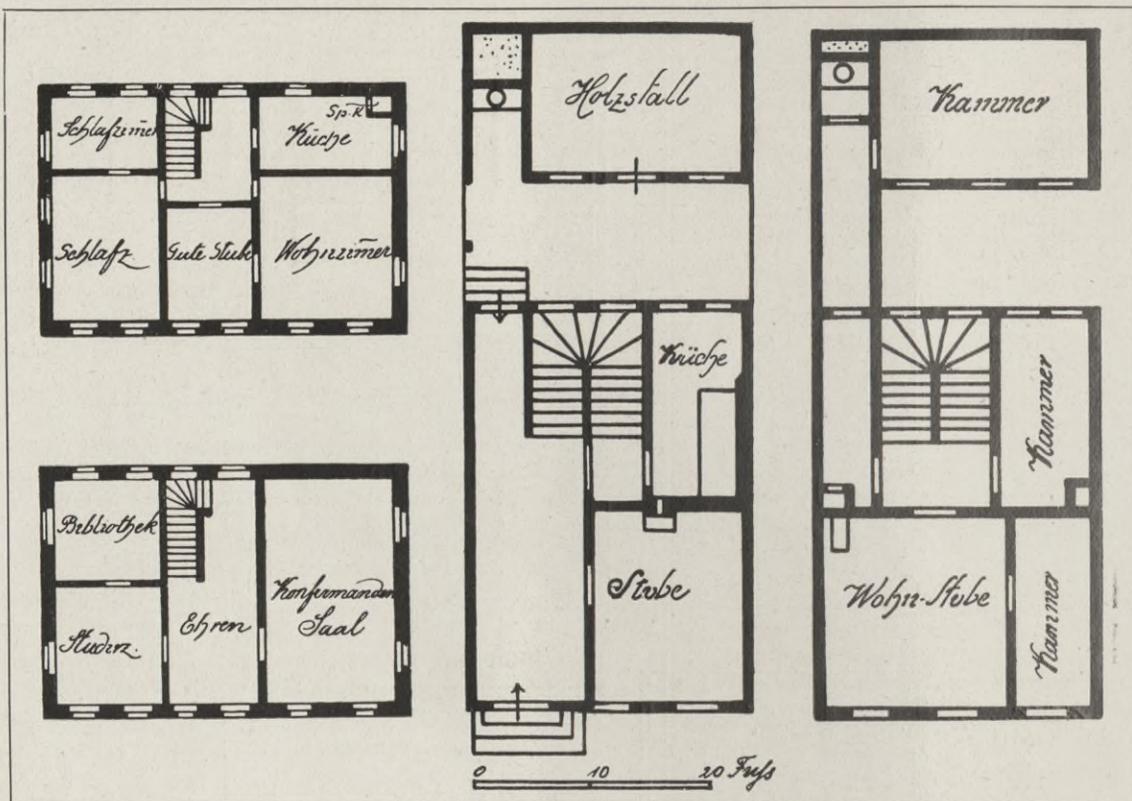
Obergeschoßgrundrisse von Bürgerhäusern
